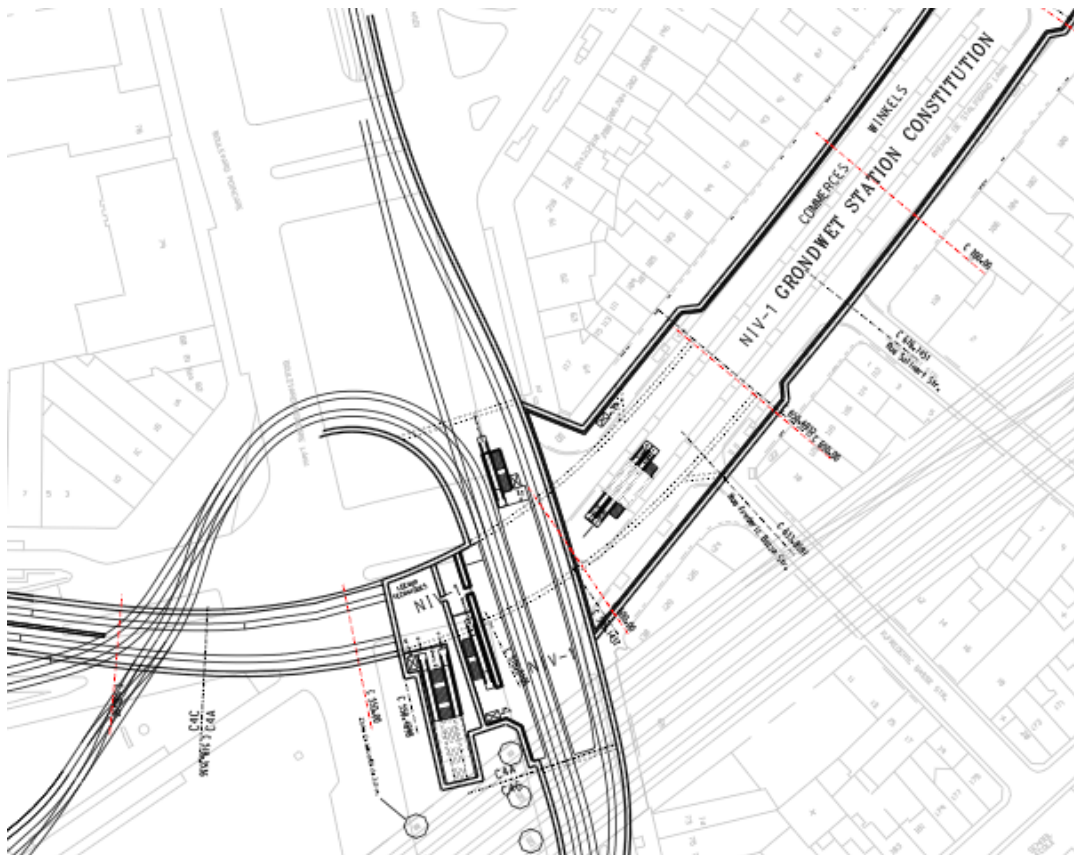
Vue en plan – circulations entre station tram et station métro ‘Constitution’
